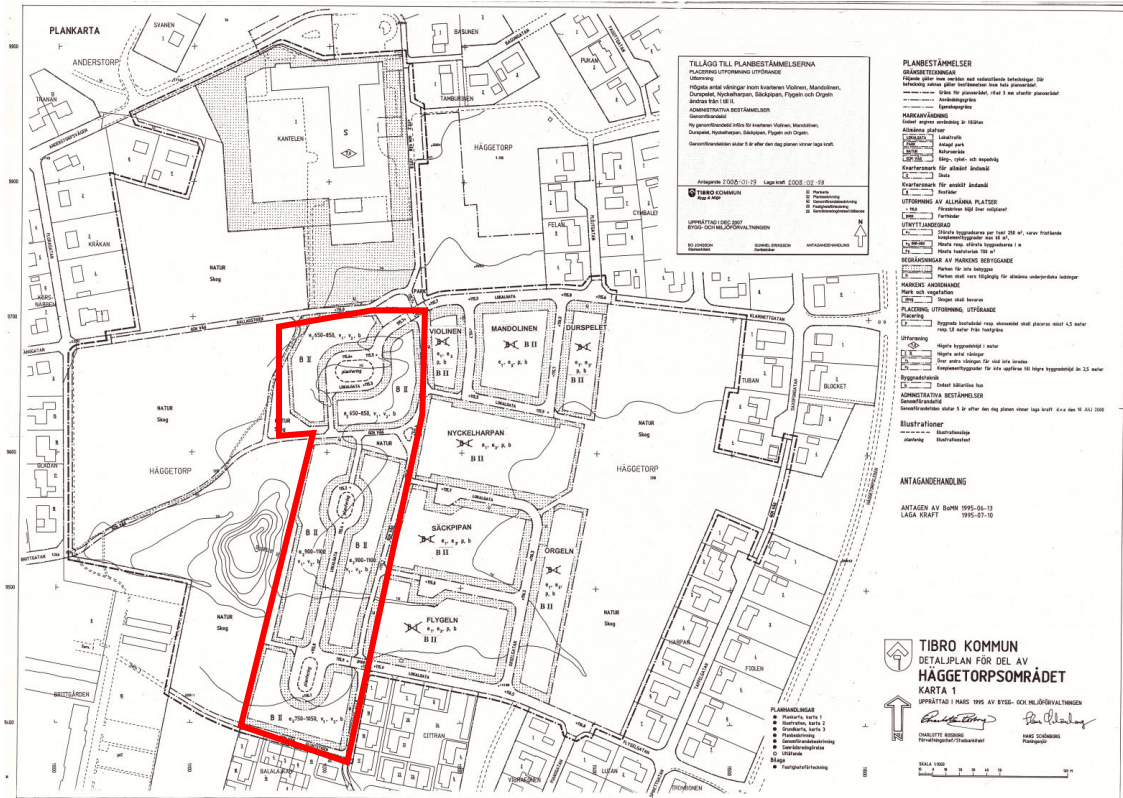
Plankarta för DP 179, föreliggande planförslags planområde markerat i rött.
